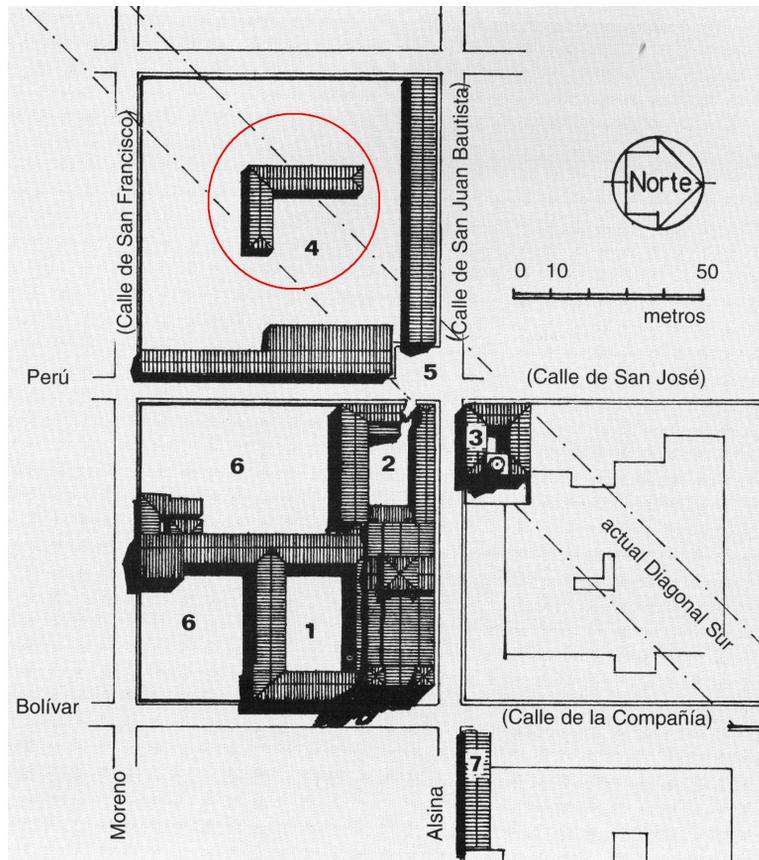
Reconstrucción del complejo jesuítico de Buenos Aires, destacando la vivienda de trabajadores esclavizados (De Paula, 1997, p.63).
